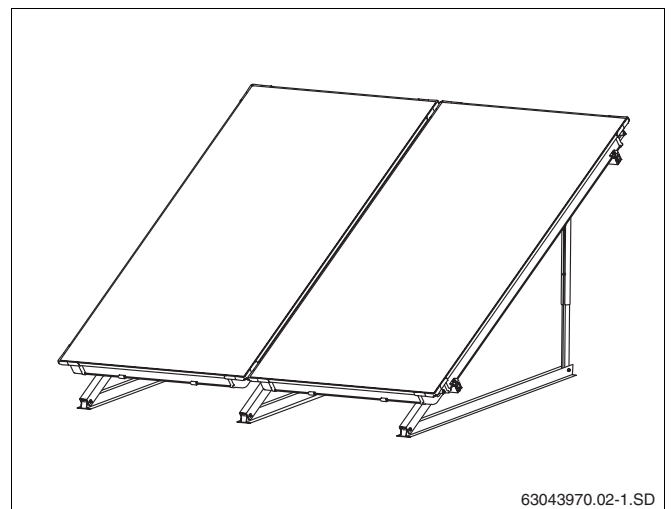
Imagem geral do conjunto de colectores, montagem em telhado plano
